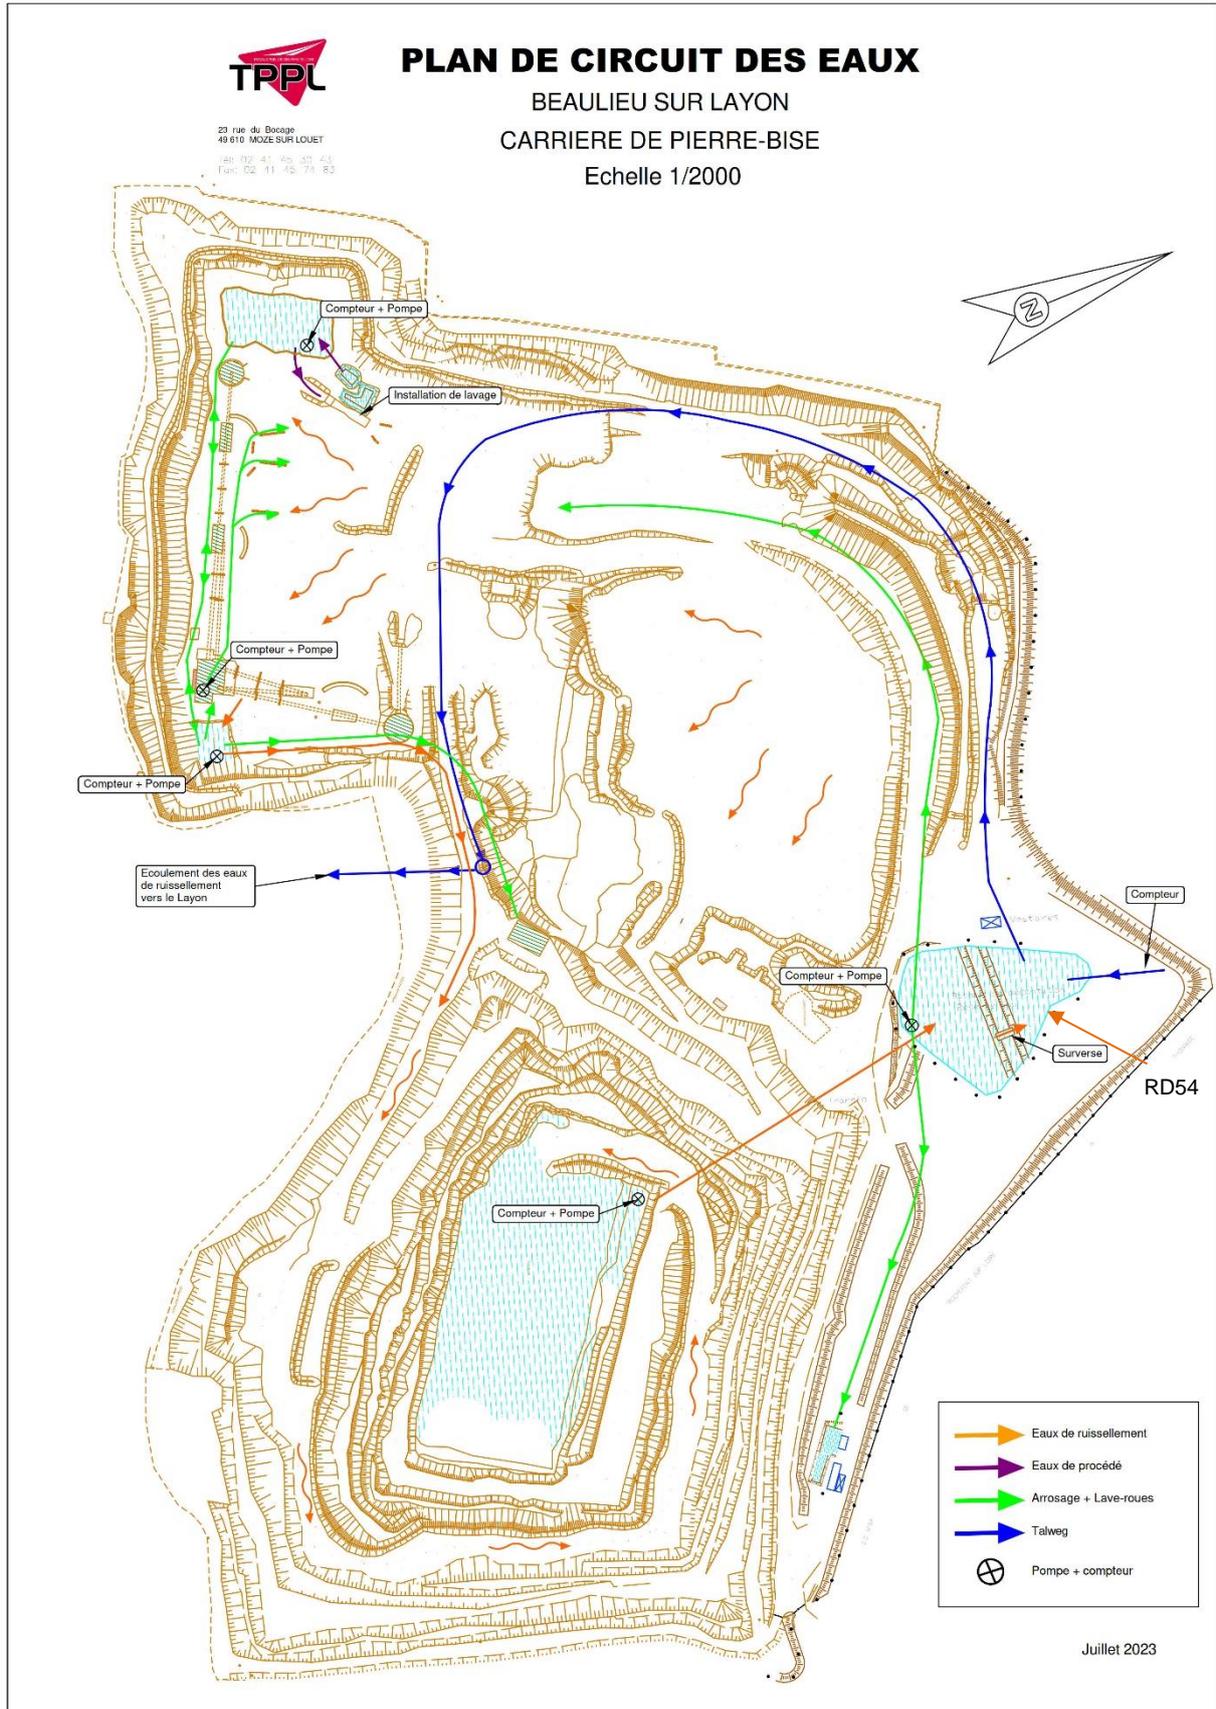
Plan de gestion des eaux prévu de la carrière de Pierre Bise
